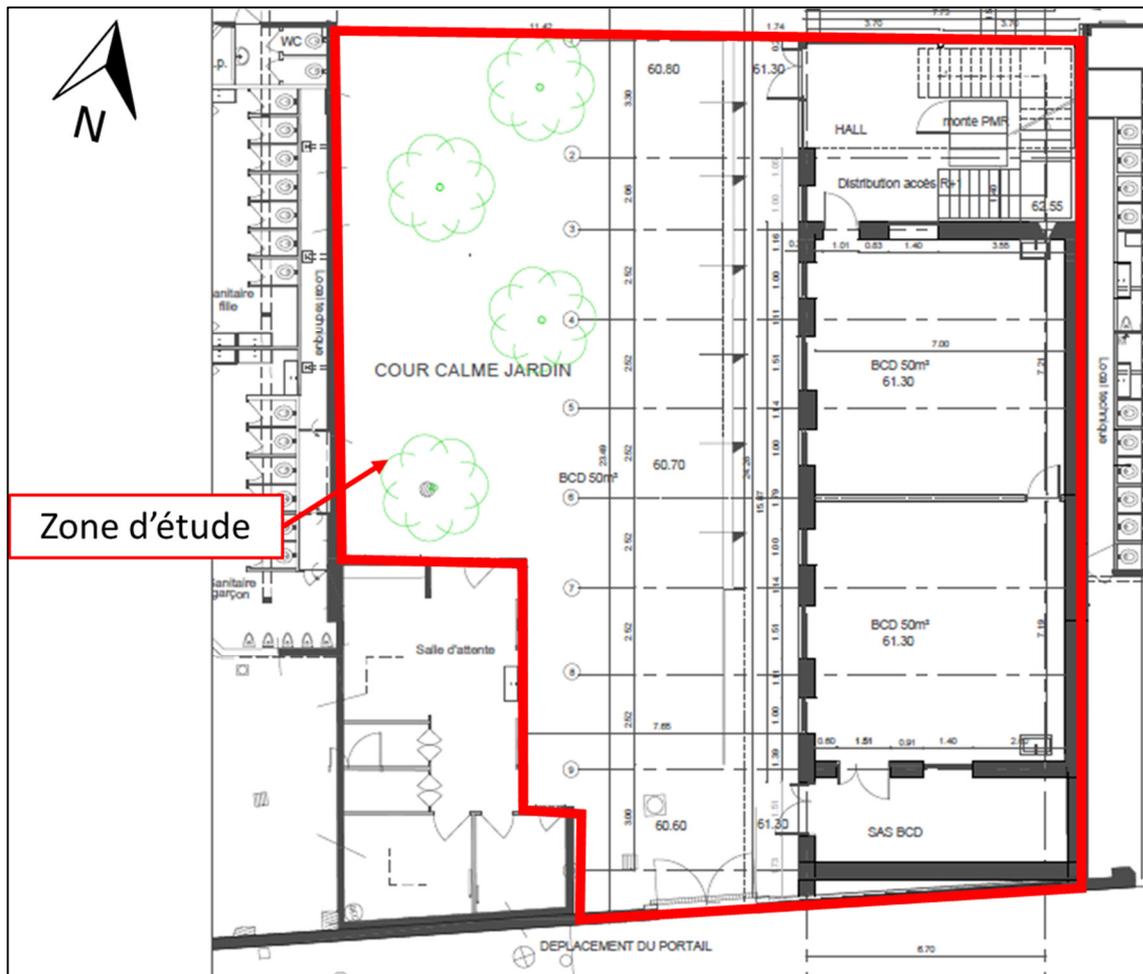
Plan de masse du projet (source : Ville de Paris)
